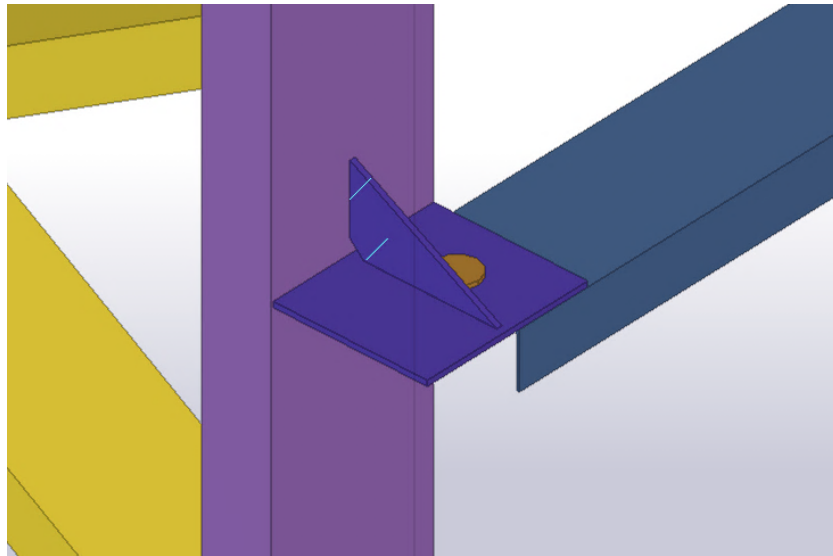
Vista tridimensional da ligação pilar | plinto no Tekla Structures 2019i
